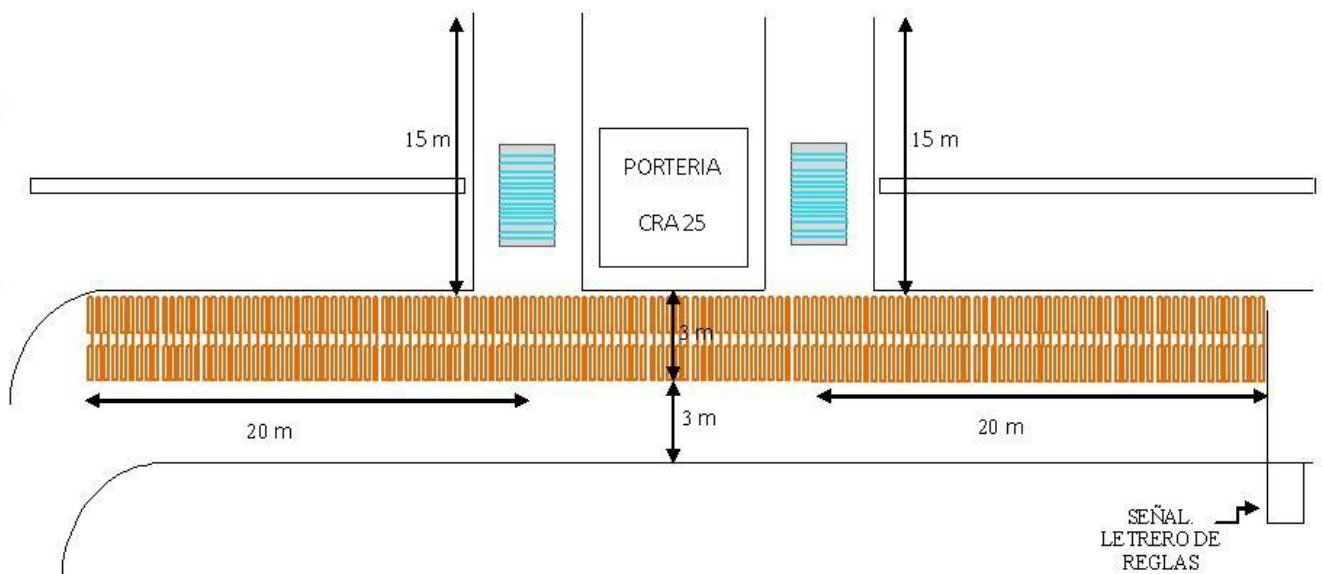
Entrada carrera 30 teniendo instalado teniendo instalados los dispositivos de Electro Kinetic Road Ramp e Innowatech.
